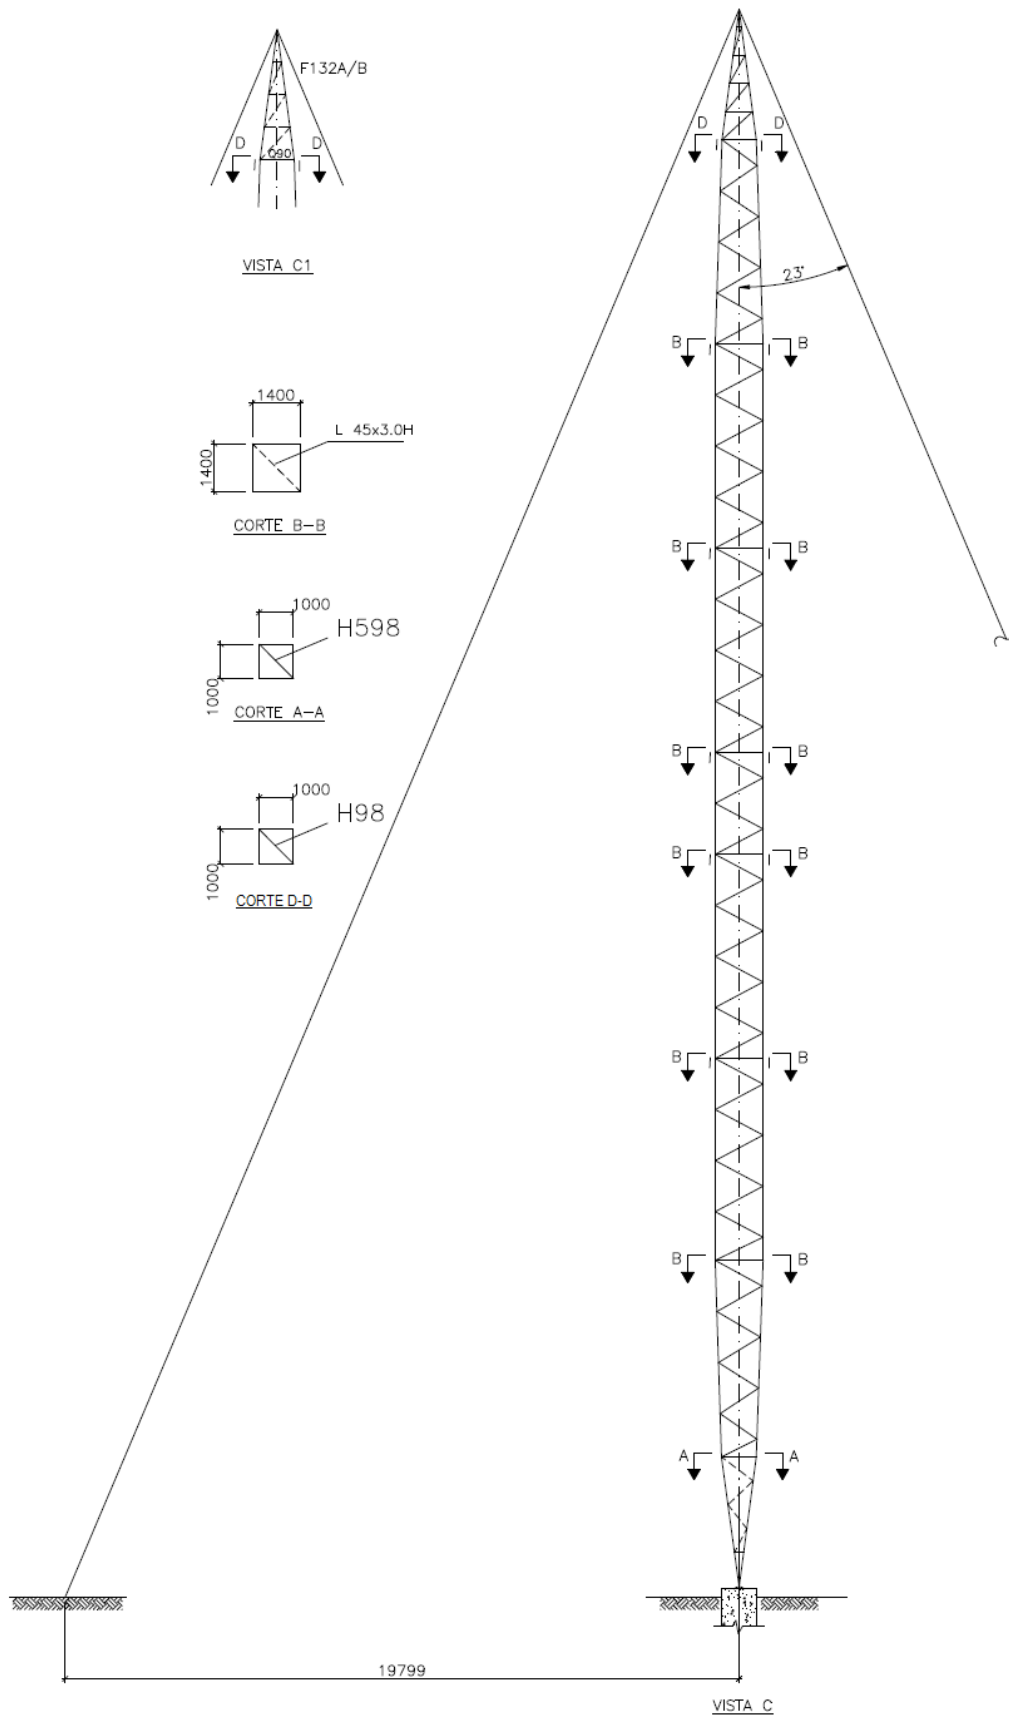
Vista longitudinal da torre estaiada cross rope
